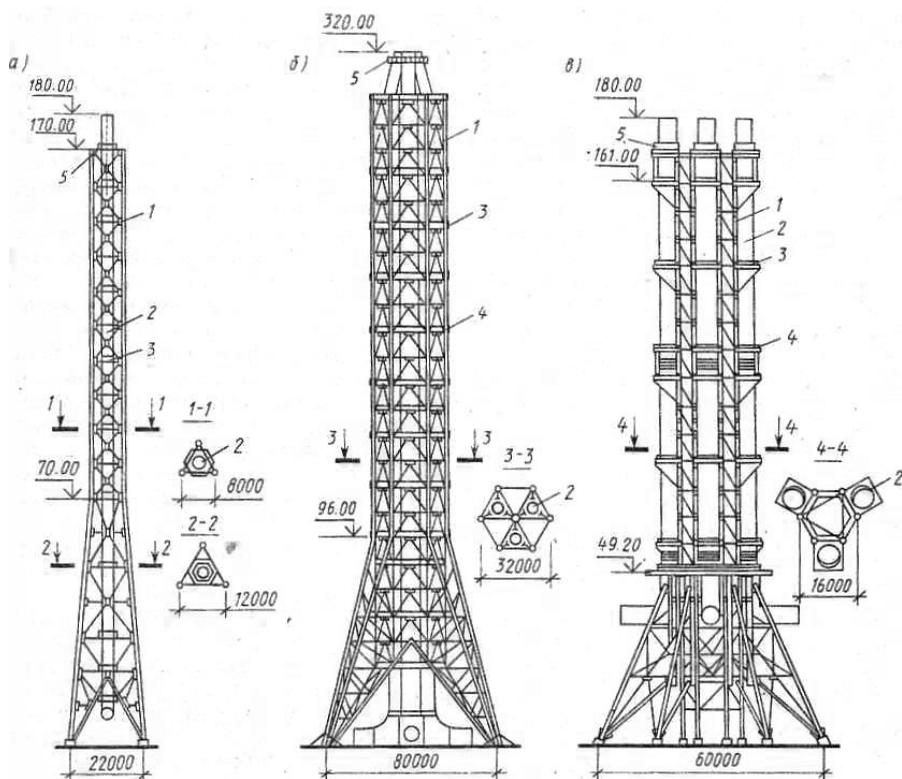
Примеры конструкций вытяжных башен: а – с одним; б – с тремя газоходами, расположенными внутри несущей решетчатой башни; в – с тремя газоходами, расположенными снаружи несущей решетчатой башни; 1 – стальная решетчатая башня; 2 – стальной газоход; 3 – площадка для крепления газоходов; 4 – площадки для контроля и обслуживания; 5 – светофорные площадки
